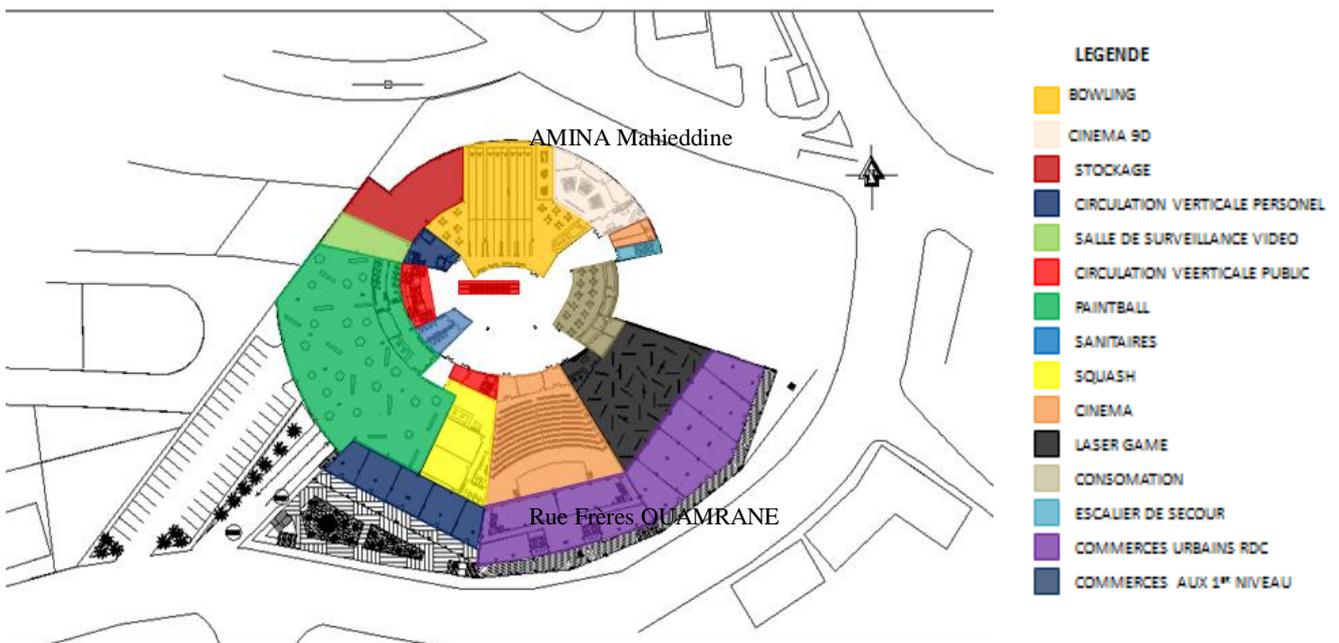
Plan traité du premier sous-sol au niveau -5.10.
